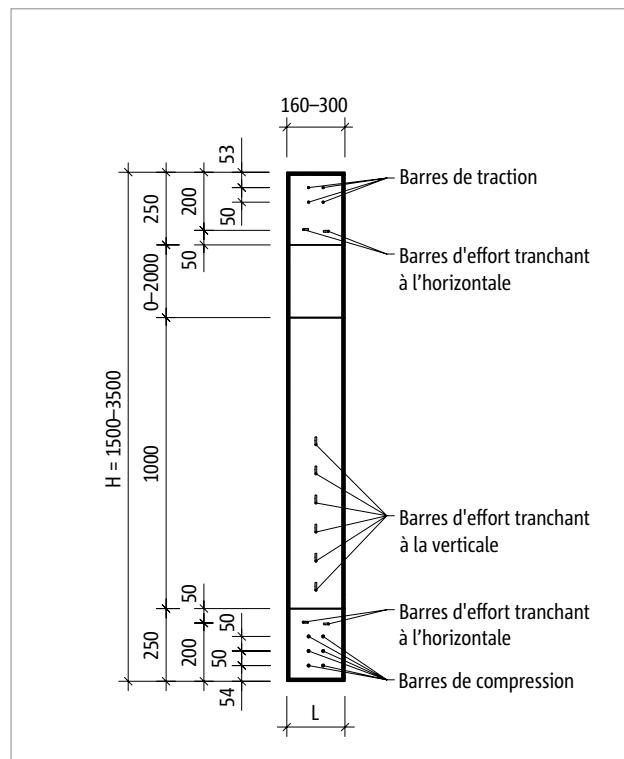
Schöck Isokorb® T type W-M1-R90 : vue du produit ; plaques coupe-feu sur tout le pourtour
